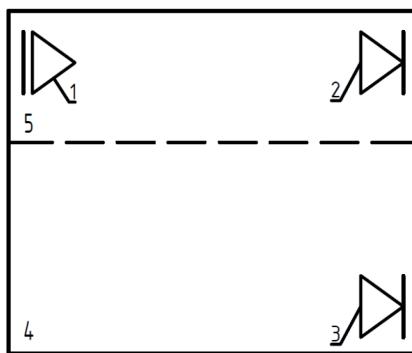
Схема удаления воздуха из верхней и нижней зон помещения:
